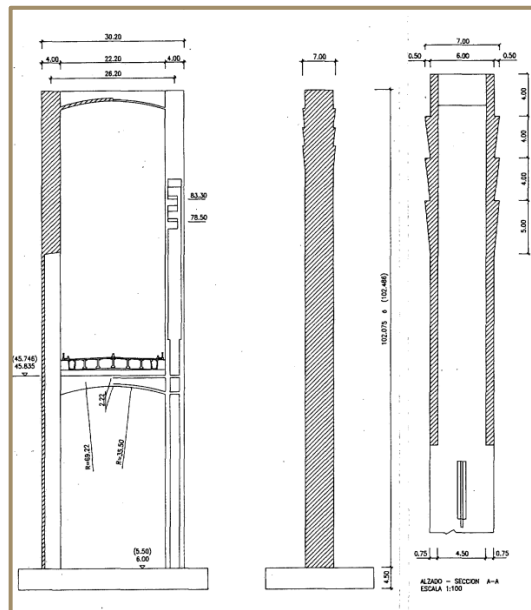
Sección y alzado de las pilas del Puente del Centenario, Sevilla
